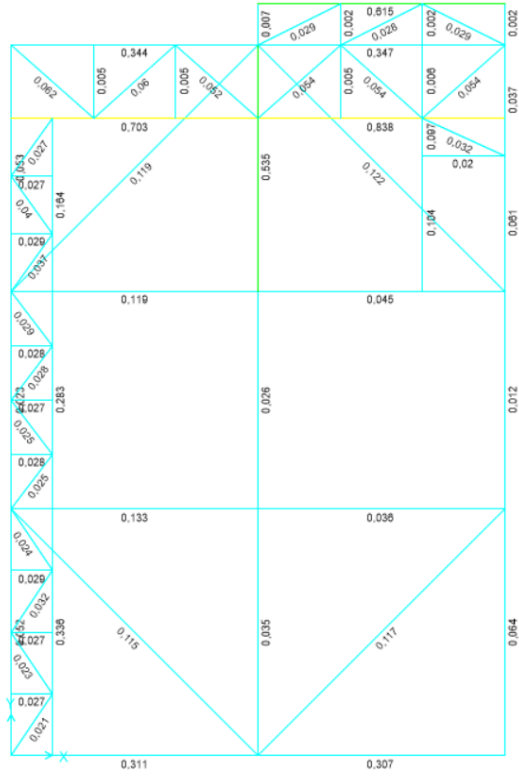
Factores de utilización vista en planta elevación 4.8 m.
